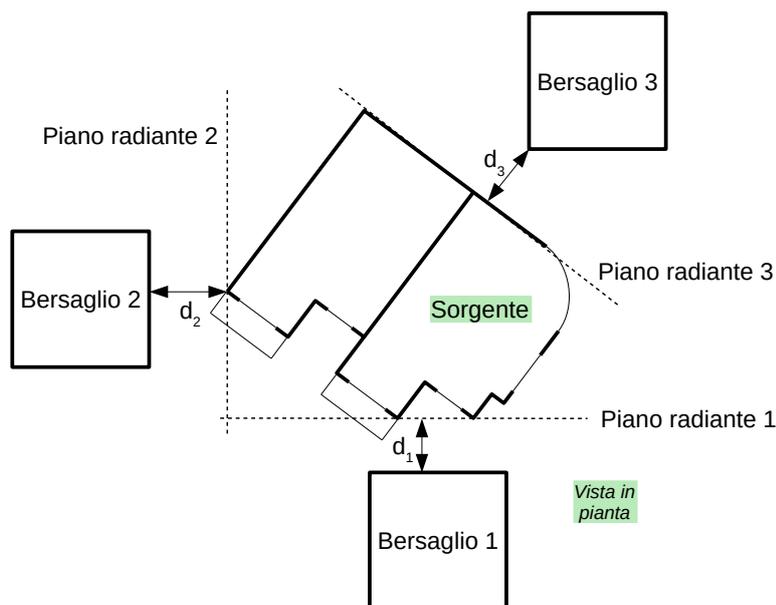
Determinazione del piano radiante, vista in pianta delle costruzioni
